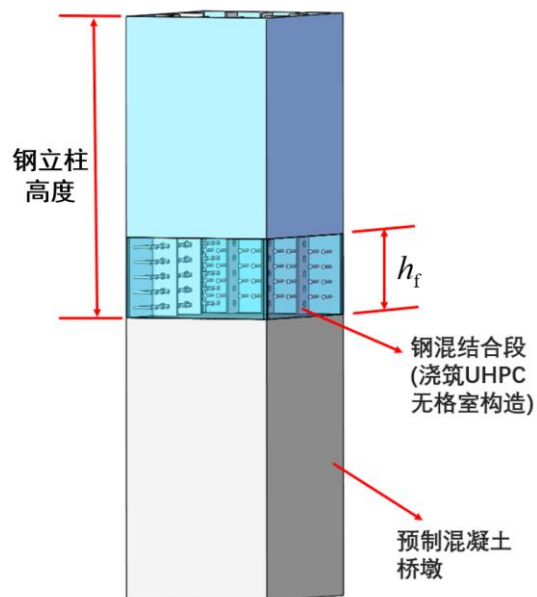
钢-混凝土组合柱湿接缝连接方案
